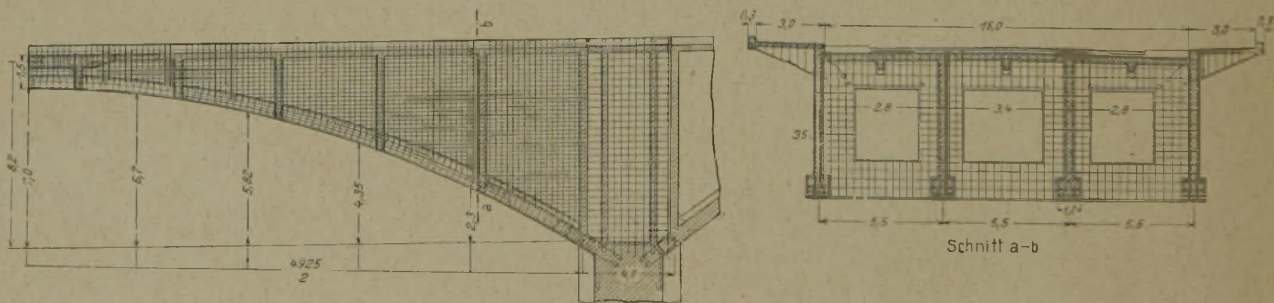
Längs- u. Querschnitt mit Bewehrung der kleinen Brückenbogen. (rd. 1 : 300.)
